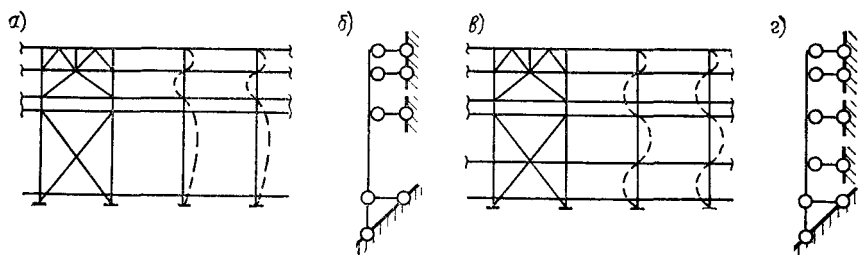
Связи между колоннами и расчетные схемы колонн из плоскости рам
